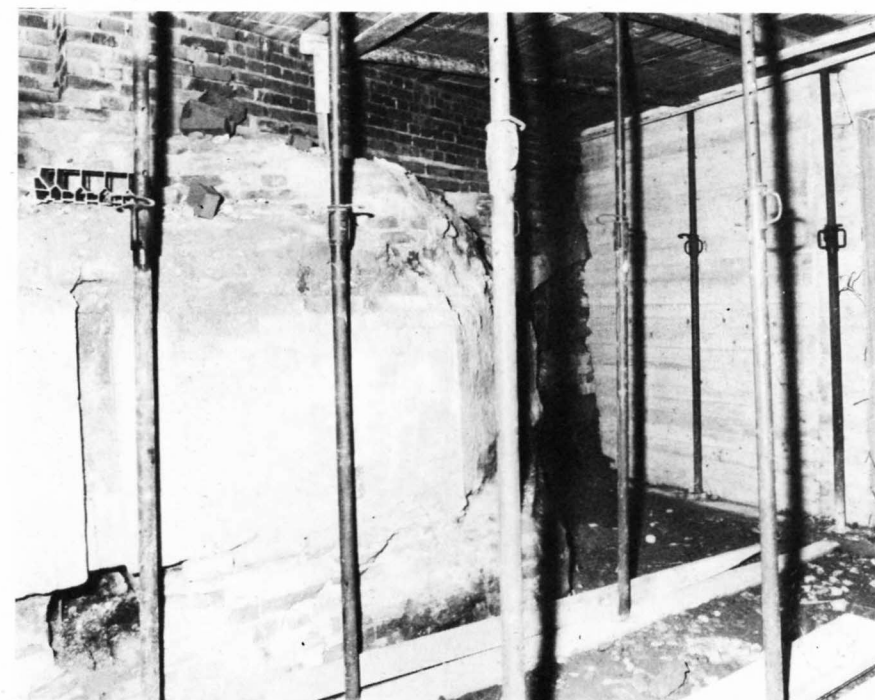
Opera muraria medioevale: lato ovest - pila rostrata con guida in vivo di pietra e alloggio della trave di fondo (ammortizzatore).
